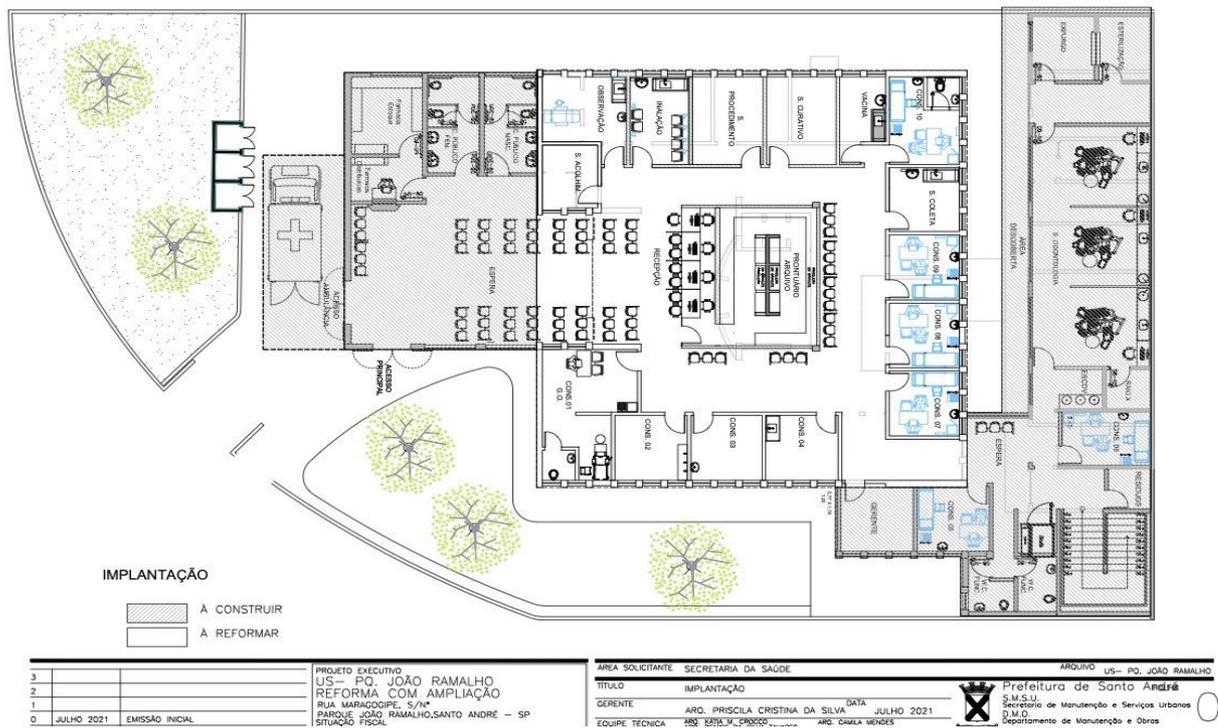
US João Ramalho. Planta do pavimento térreo mostrando as ampliações no hachurado.
